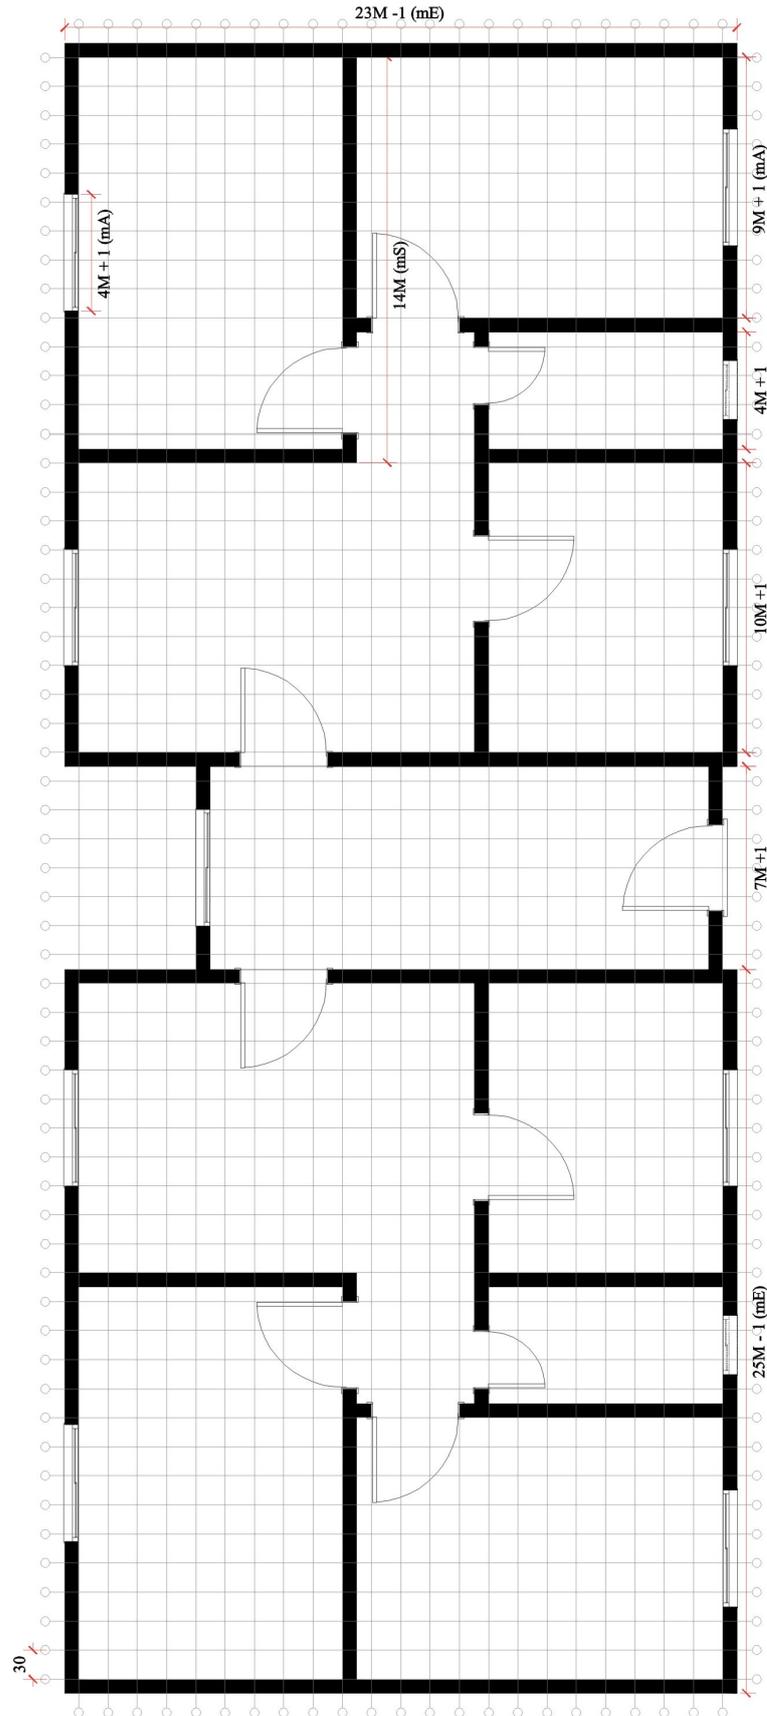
planta baixa do pavimento tipo do projeto piloto, segundo o quadriculado multimodular de referência 3M, com base no projeto da figura 97
